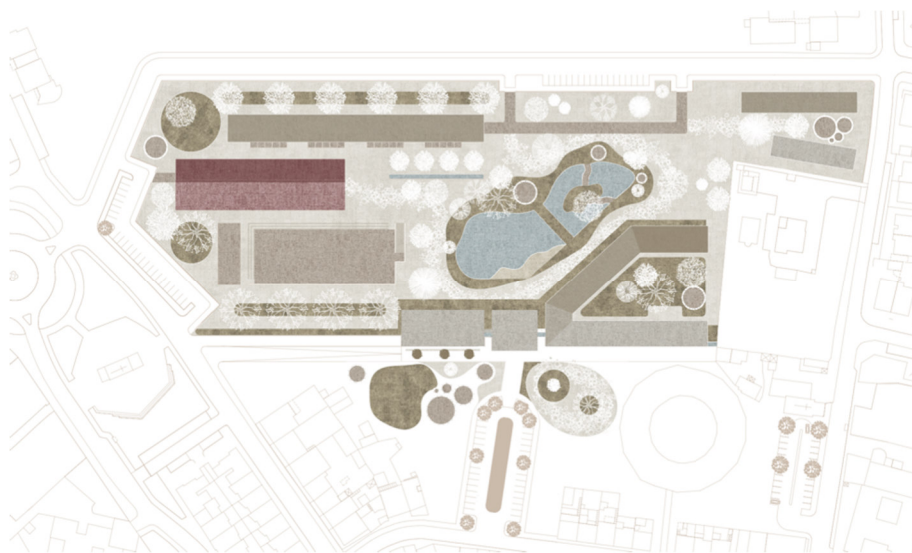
12 - Planta de Implantação da proposta de Projeto
